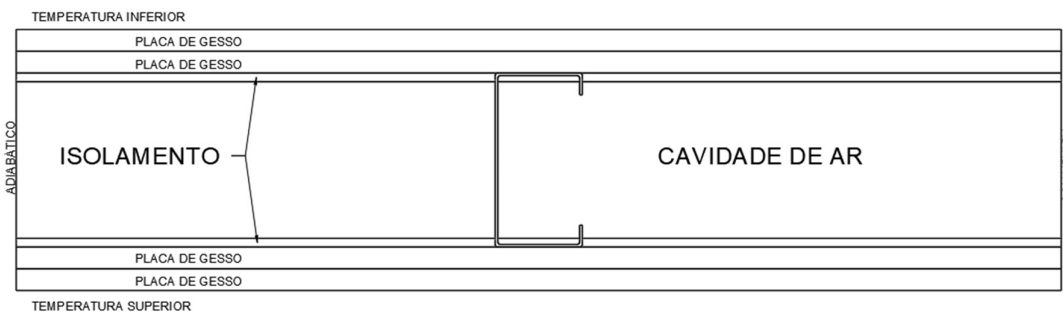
Modelo para perfil em C com duas placas de gesso e isolante de espessura total 10 mm.
